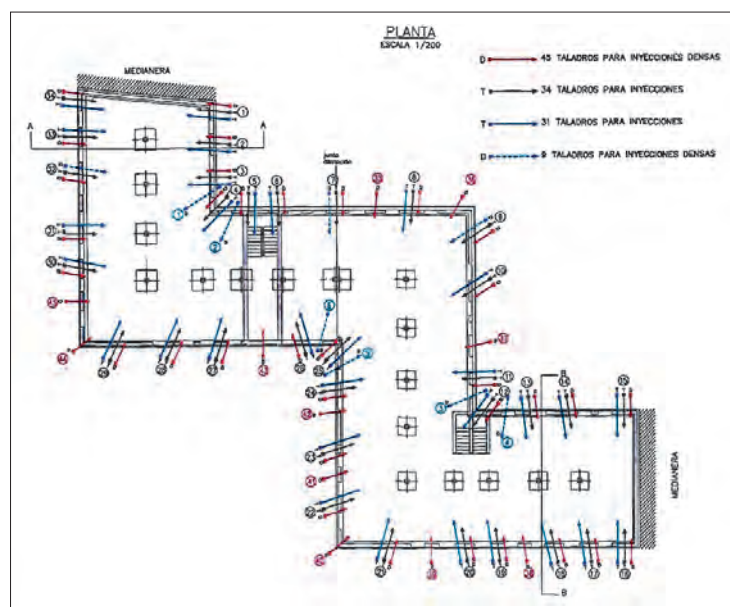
PLANTA DEL EDIFICIO DE LA FIGURA 30 Y SITUACIÓN DE INYECCIÓN.
